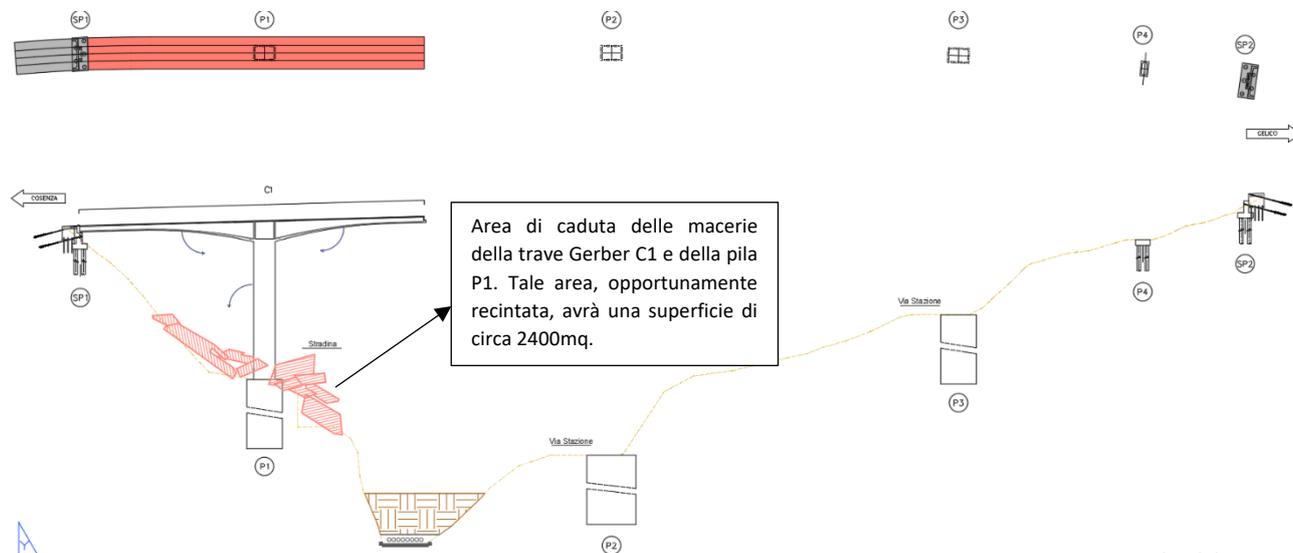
Estratto elaborato V382026002APA “Tavola della fasizzazione dell’intervento di demolizione (5 di 5)”
